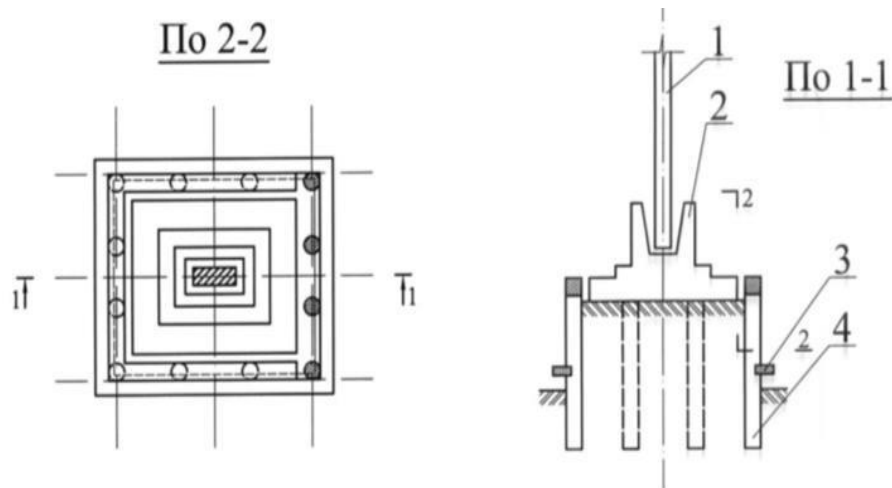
Усиление основания ограждающими сваями: 1 – колонна; 2 – фундамент; 3 – обвязочная балка; 4 – сваи усиления
